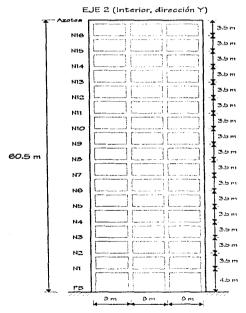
Eje 2 de las estructuras de 17 niveles, análisis paso a paso con el DRAIN-2D
